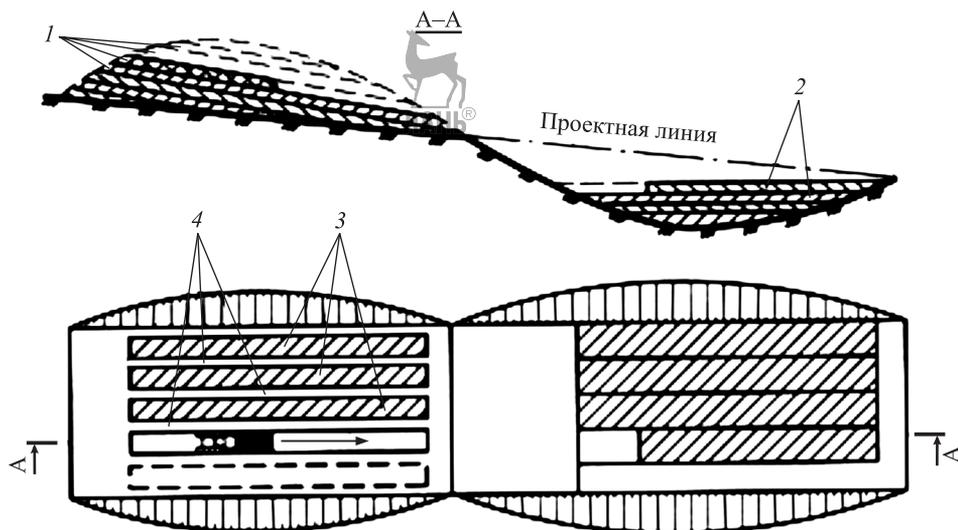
Траншейно-ярусная схема разработки грунта бульдозером:
